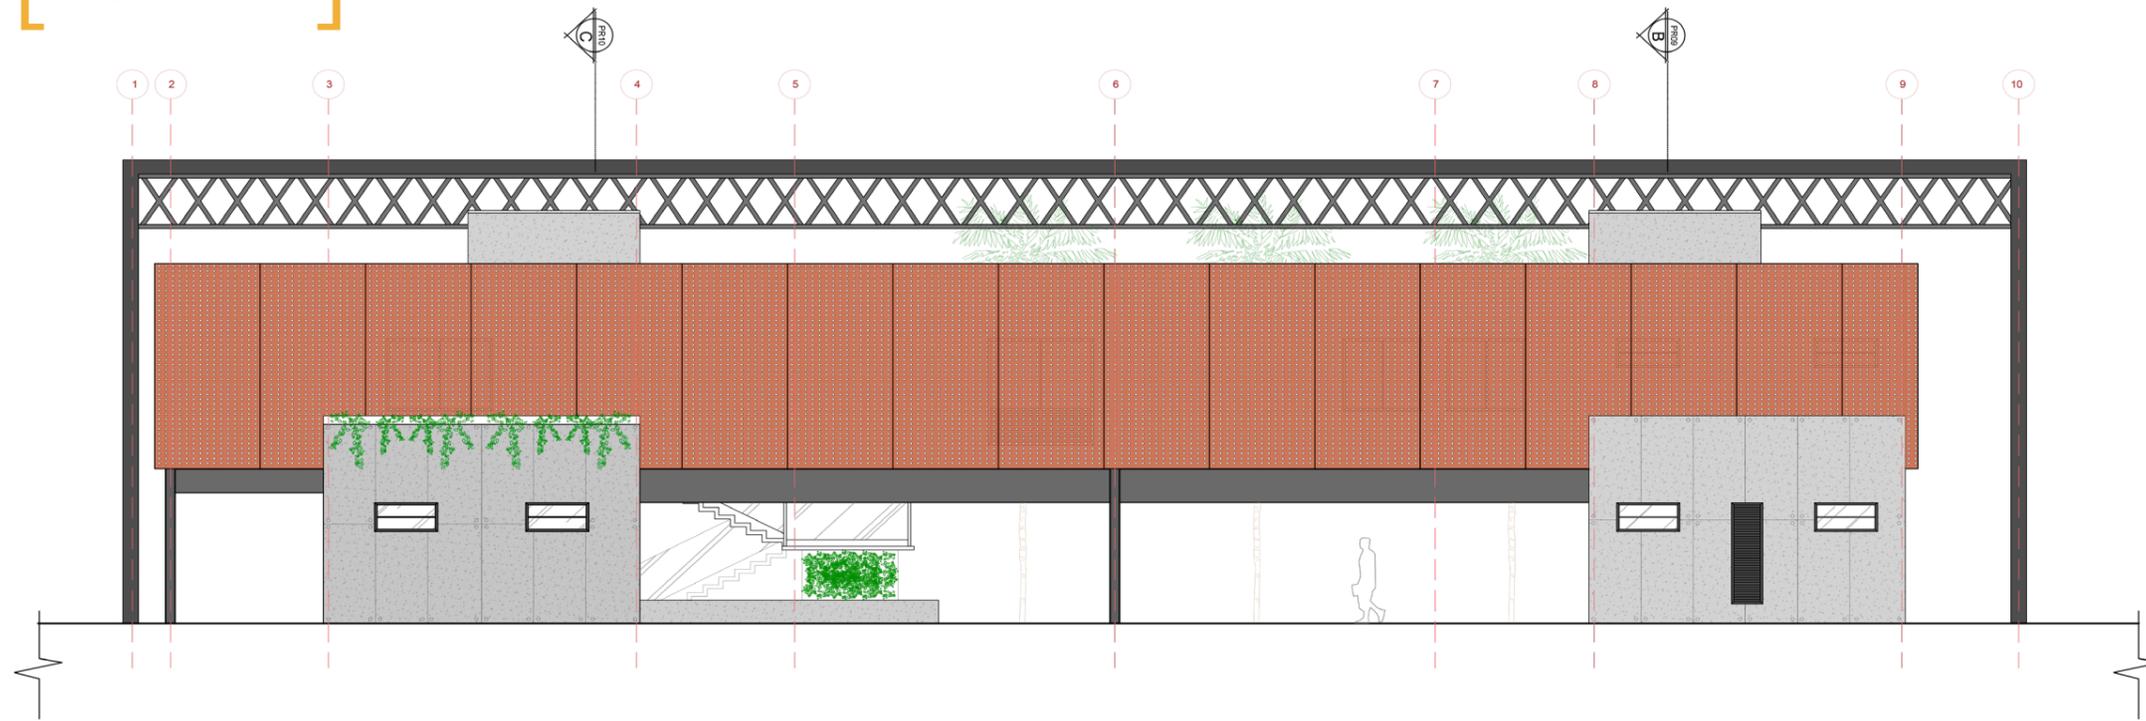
FACHADA V3_ Fonte_ Elaborada pelo Autor
